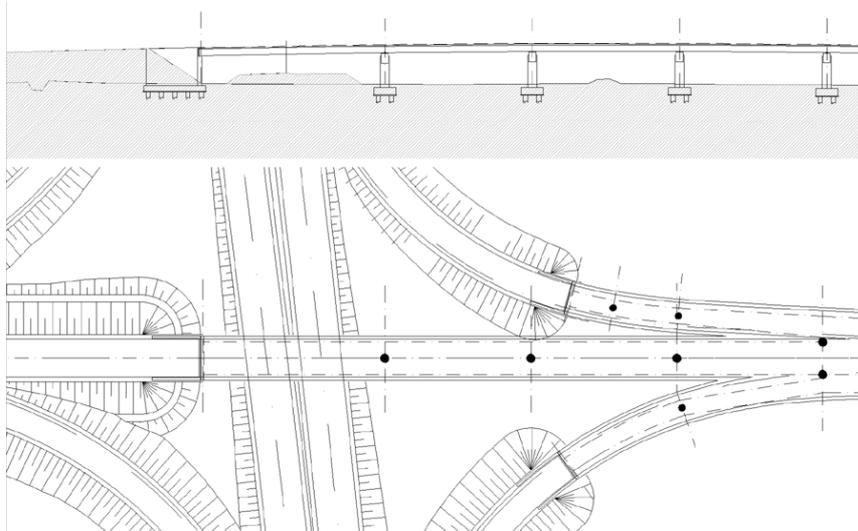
G Viadotto di Svincolo – Pianta e prospetto
